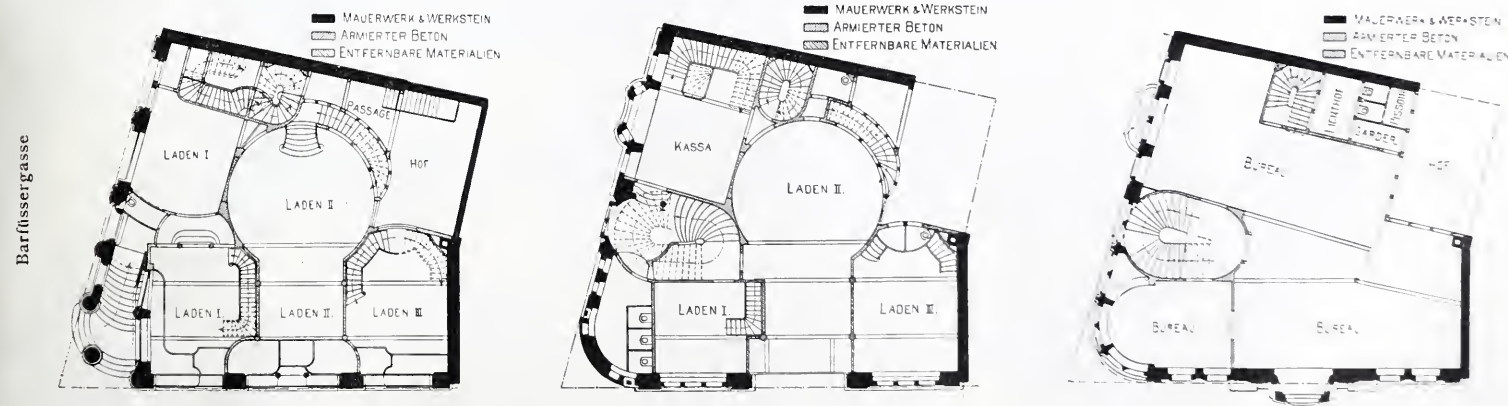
Das Haus «zum Sodeck», Freie Strasse Nr. 74. Grundrisse vom Erdgeschoss, vom Zwischengeschoss und vom II. Obergeschoss. — Masstab 1 : 400.
